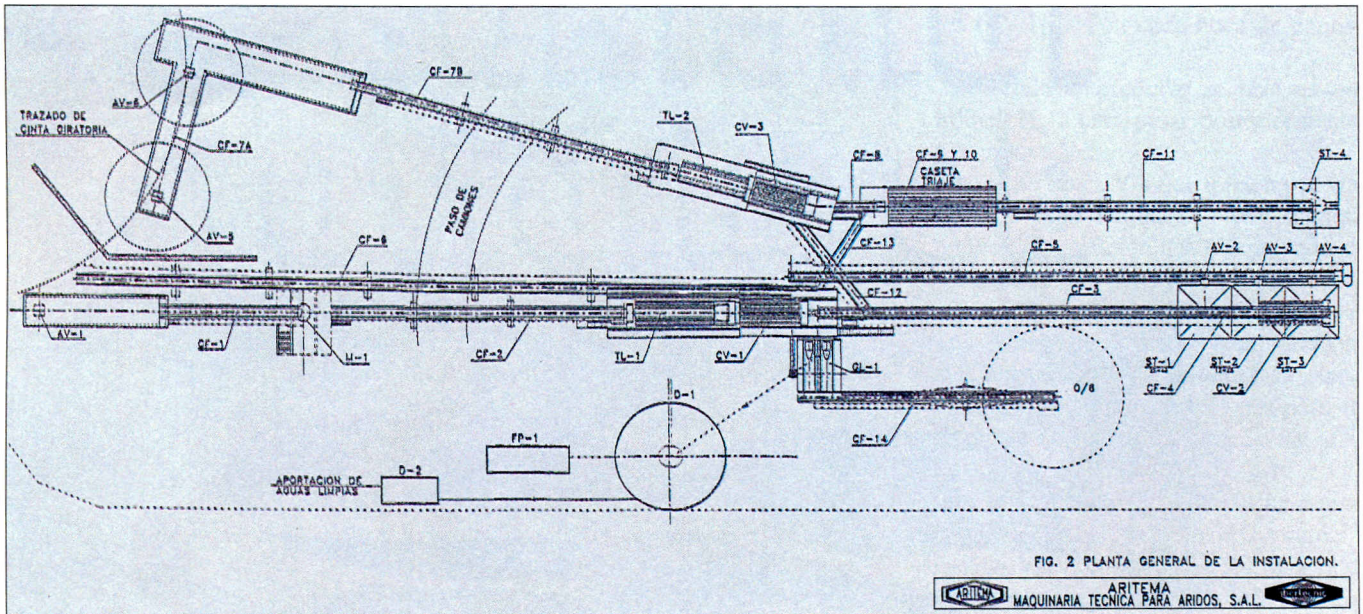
PLANTA GENERAL DE LA INSTALACION.
